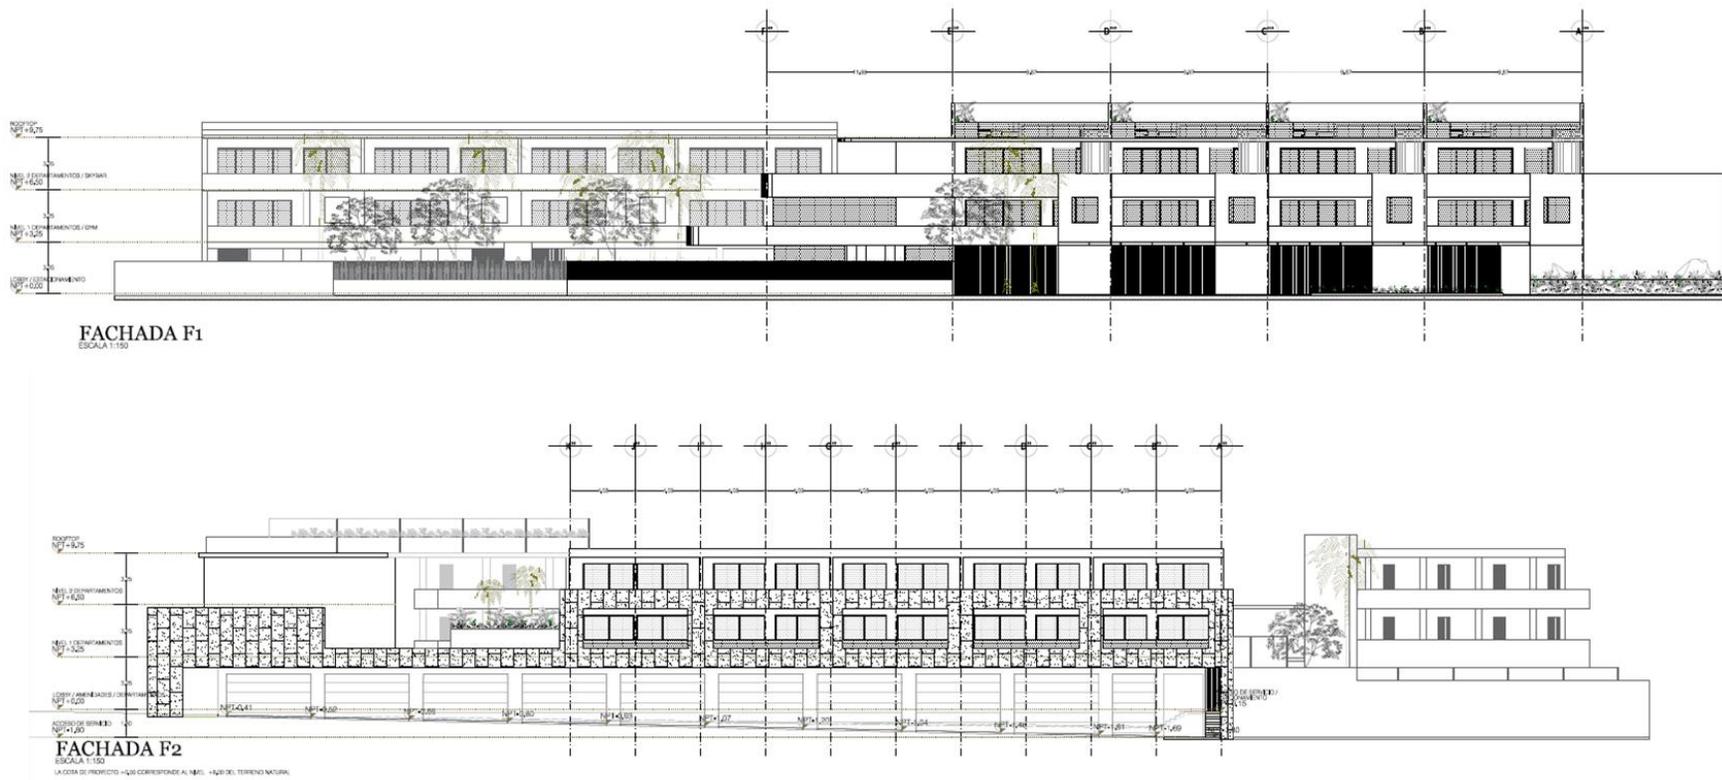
Fachada del proyecto ONE MARINA PLACE.
